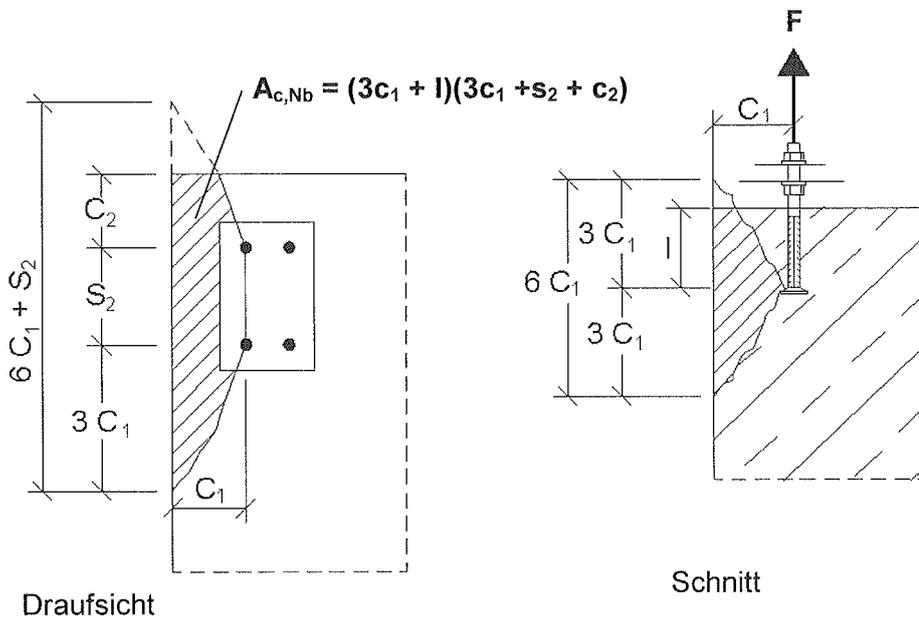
Beispiel für vorhandene Fläche $A_{c,Nb}$ des idealisierten Ausbruchkörpers bei lokalem Betonausbruch am Bauteilrand
